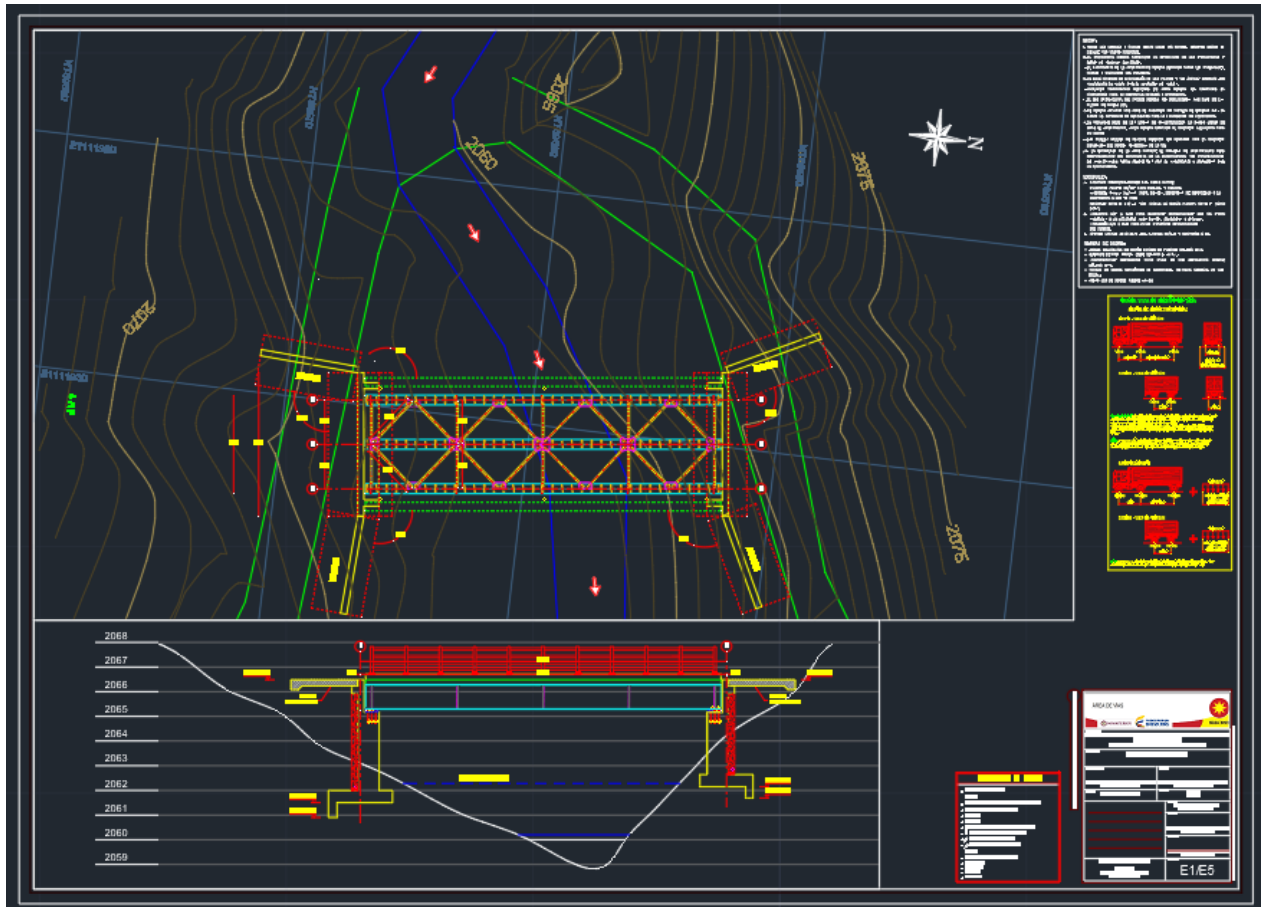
Vista en Planta de la Estructura metálica del Puente Vehicular Cresta de Gallo.
